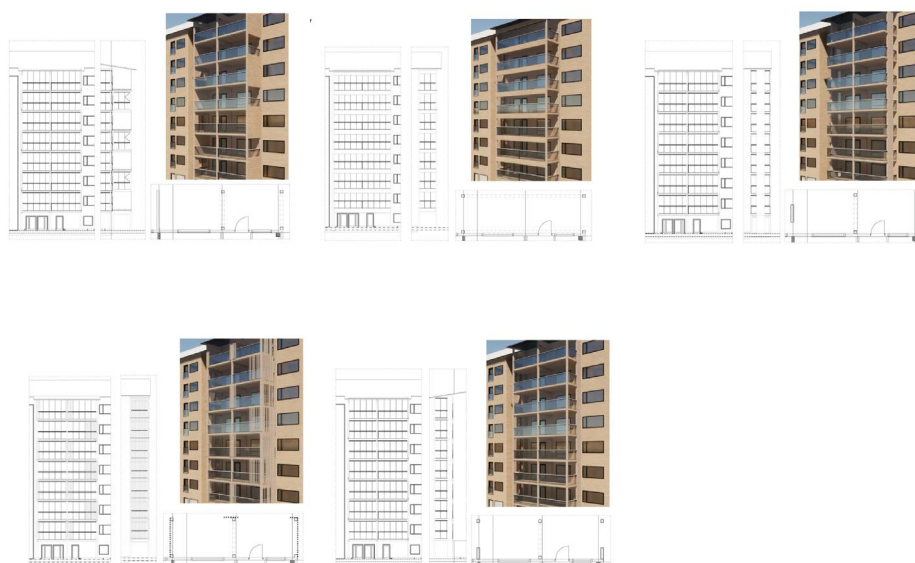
Varias soluciones para balcones, propuestas por Stora Enso: pilares y panel a un lado, pilares sólo en extremos, pilares en el centro y paneles a los lados, pilares en extremos y centro, pilares y pequeños paneles
